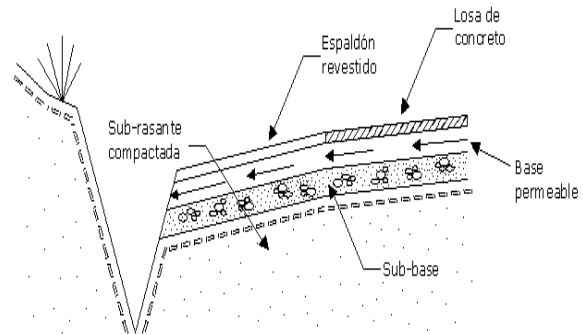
Detalle de sección típica de una estructura de pavimento con concreto hidráulico. (Fuente: Conservación de caminos: un modelo participativo).
